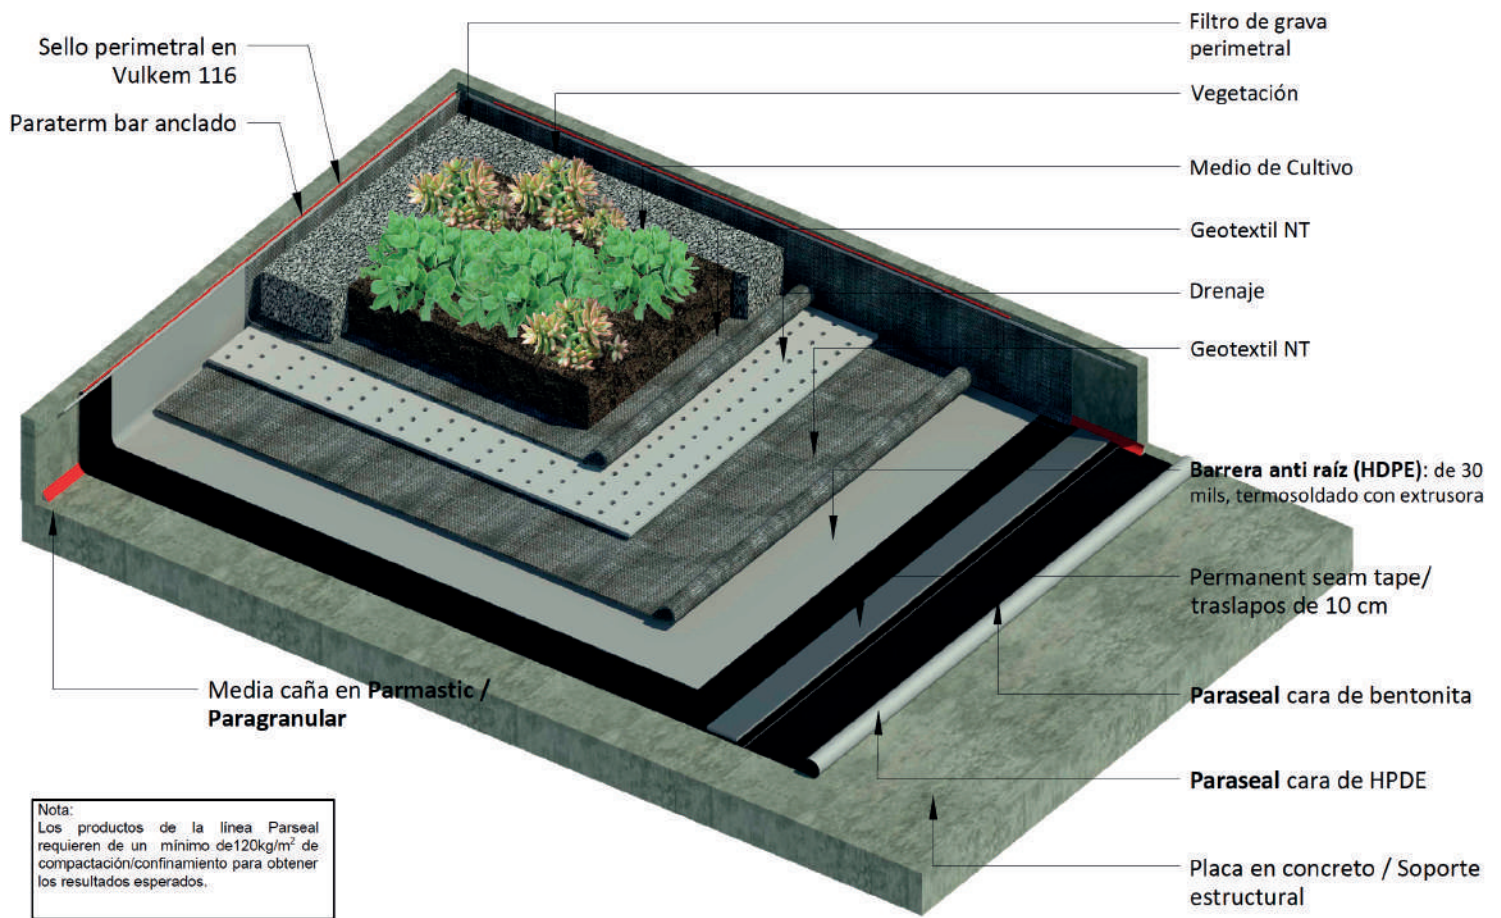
Sistema techo vegetal e impermeabilización con PARASEAL.
